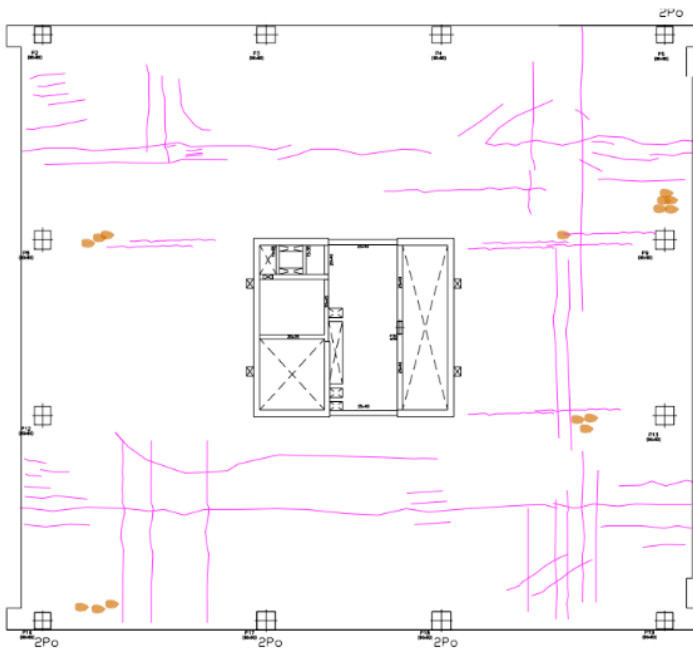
Relevamiento de fisuras en Primer Nivel.
